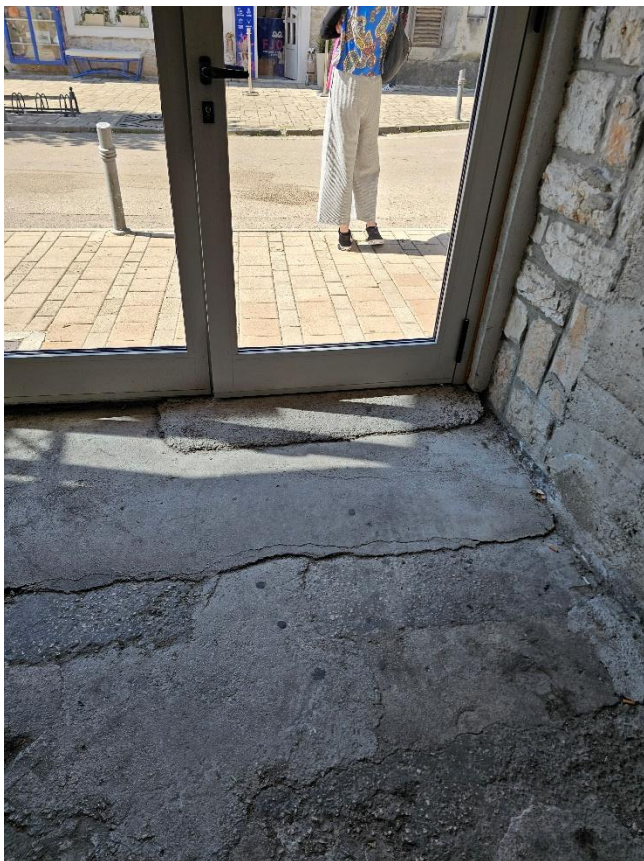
postojeće stanje – vanjska stijenka koja se zadržava i razne instalacije koje se uklanjaju
